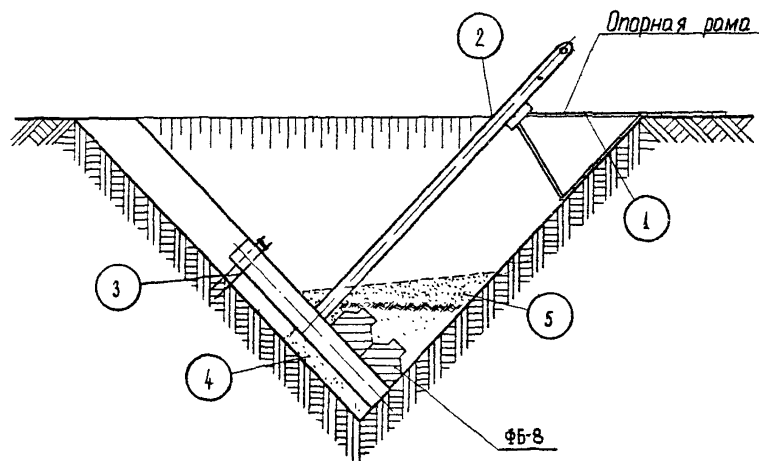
Последовательность монтажа анкерного фундамента. II этап
